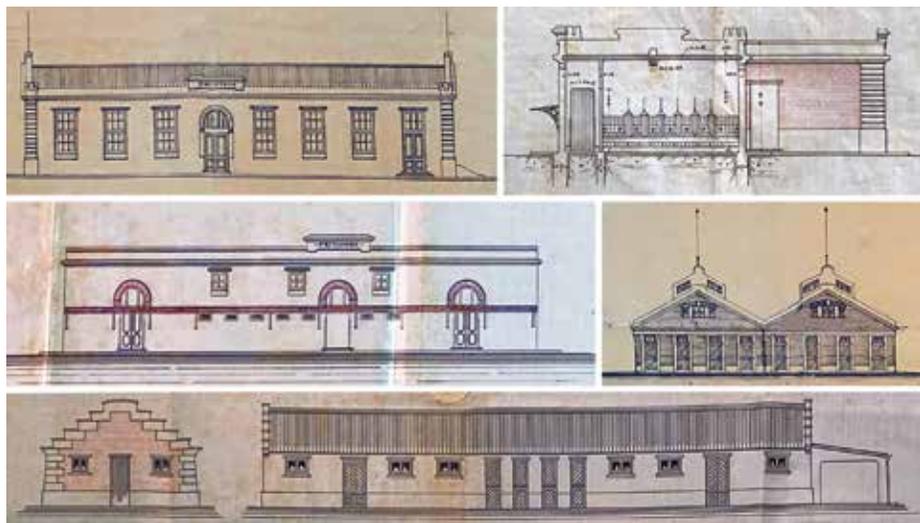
PROYECTO DE NUEVOS CUARTELES. DETALLES DE PLANOS CON FACHADAS Y CORTES DE LOS PABELLONES TIPO. DE ARRIBA A ABAJO Y DE IZQUIERDA A DERECHA: ESCUELA-BIBLIOTECA Y COMEDOR-COCINA (FACHADA LATERAL); ALOJAMIENTOS PARA LA TROPA (CORTE TRANSVERSAL); CÁRCEL Y DEPÓSITO (FACHADA FRONTAL); CABALLERIZAS Y ANEXOS (FACHADA FRONTAL); ENFERMERÍA VETERINARIA (FACHADAS FRONTAL Y LATERAL). DIVISIÓN DE CONSTRUCCIONES MILITARES, 1920.
